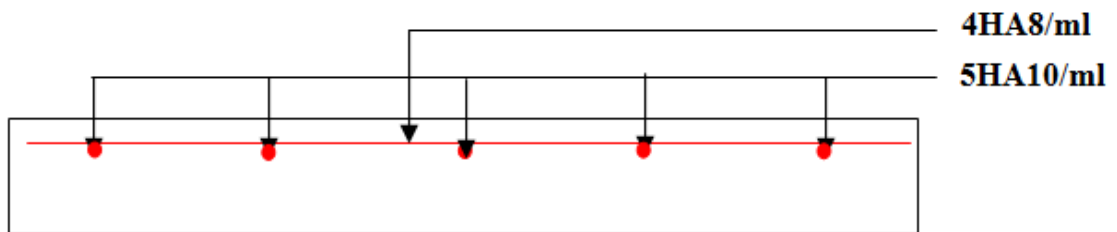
schéma de ferrailage de dalle sur deux appuis.
